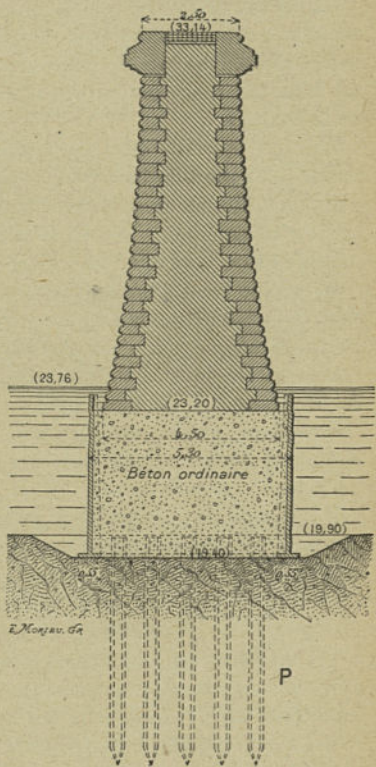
Pile de pont (nouveau viaduc d'Asnières, près Paris) établie sur un caisson en béton reposant lui-même sur un pilotis en ciment armé P.
